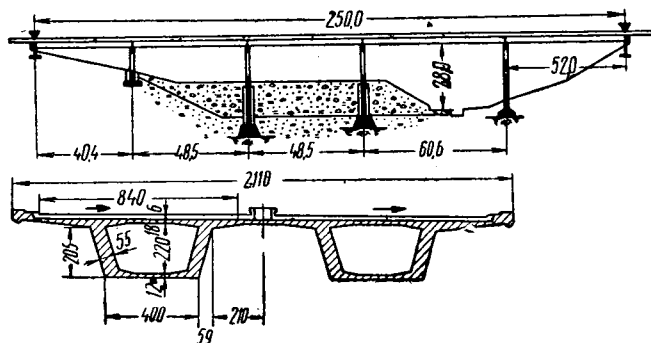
Железобетонный мост на дороге Берн—Цюрих
